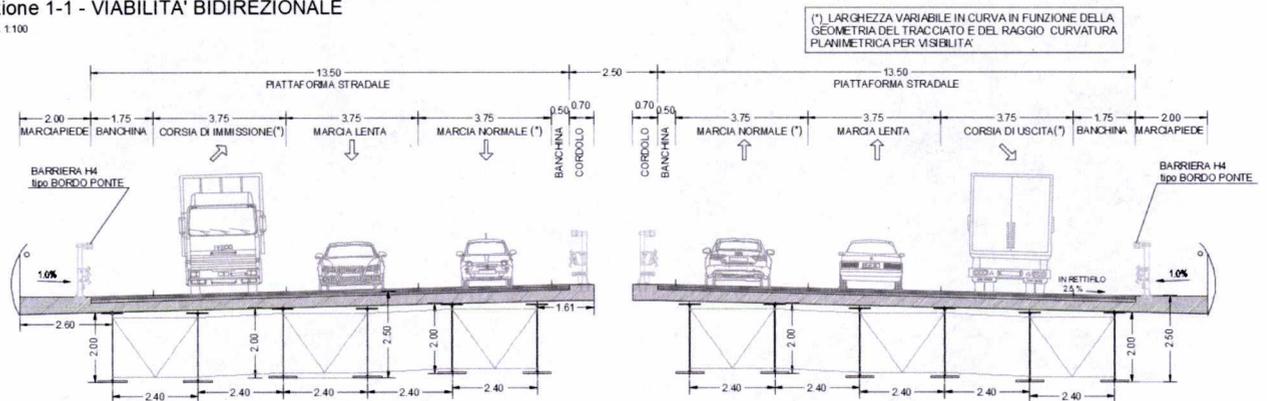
Sezione del Cavalcaferrovia Scaligeri
